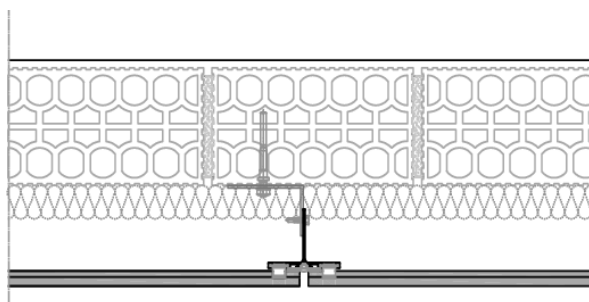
Sección horizontal. Faveton® SAH Ceram 20.
